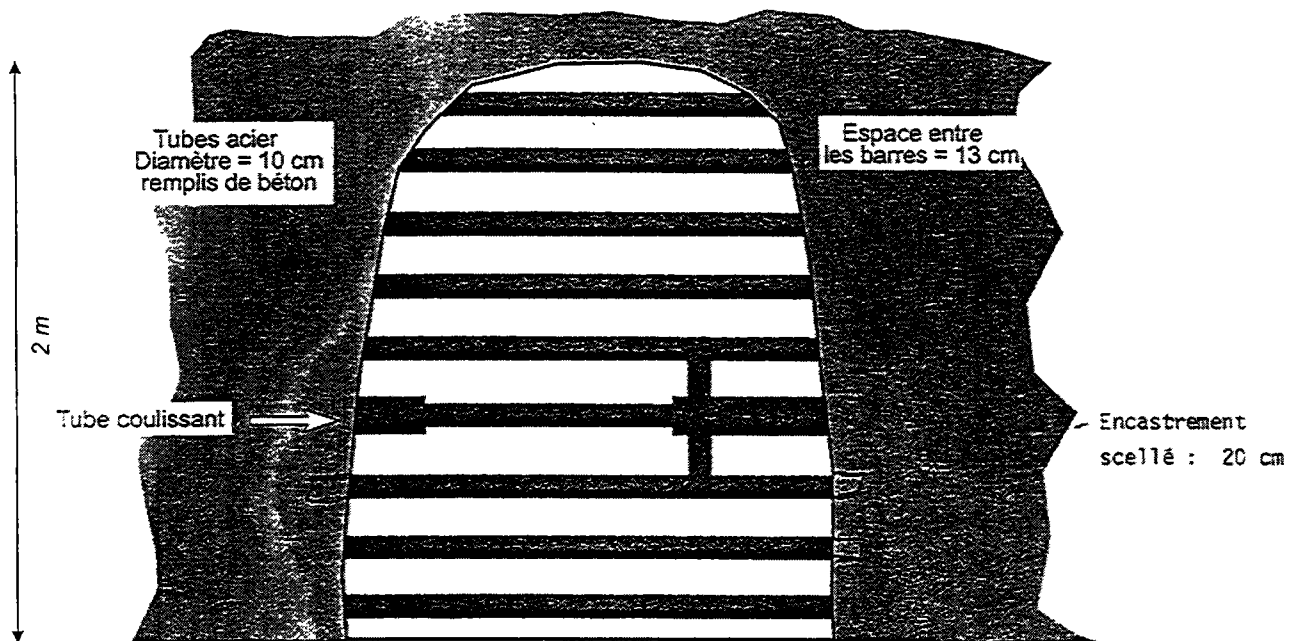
Galerie obturée par le système de barres (tubes aciers remplis de béton)
